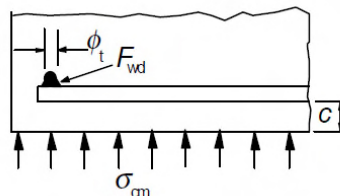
Barra transversal soldada utilizada como dispositivo de anclaje
